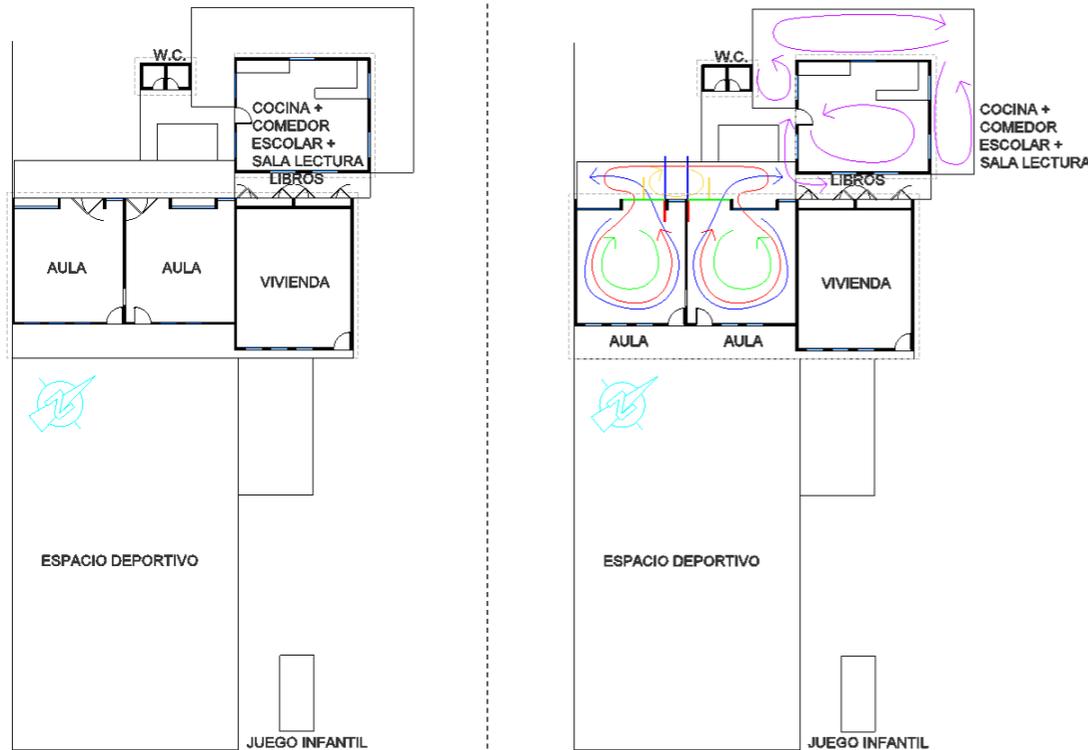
Izq. Planta arquitectónica. Der. Planta estructural. Fuente: elaboración propia.
